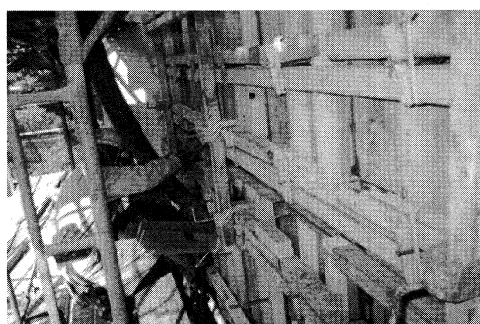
コンクリートの打設状況（型枠中段部の小窓から打設）
